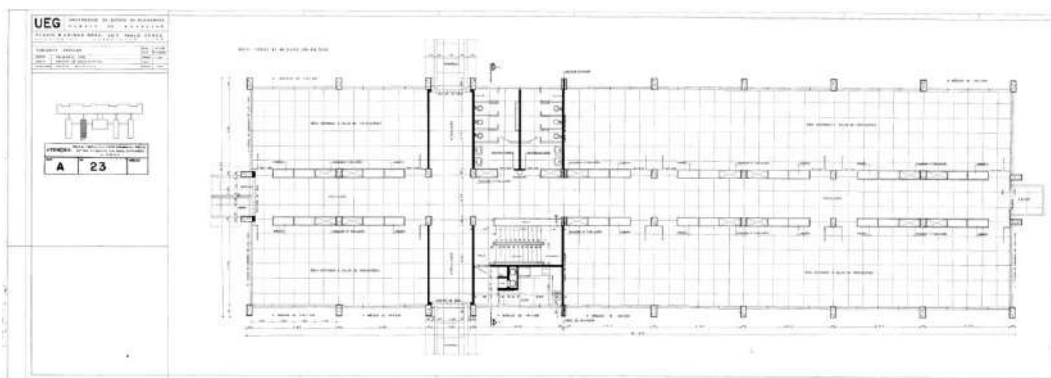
UERJ. Conjunto Escolar. Pavimento Tipo. Projeto definitivo. Blocos H,I.
